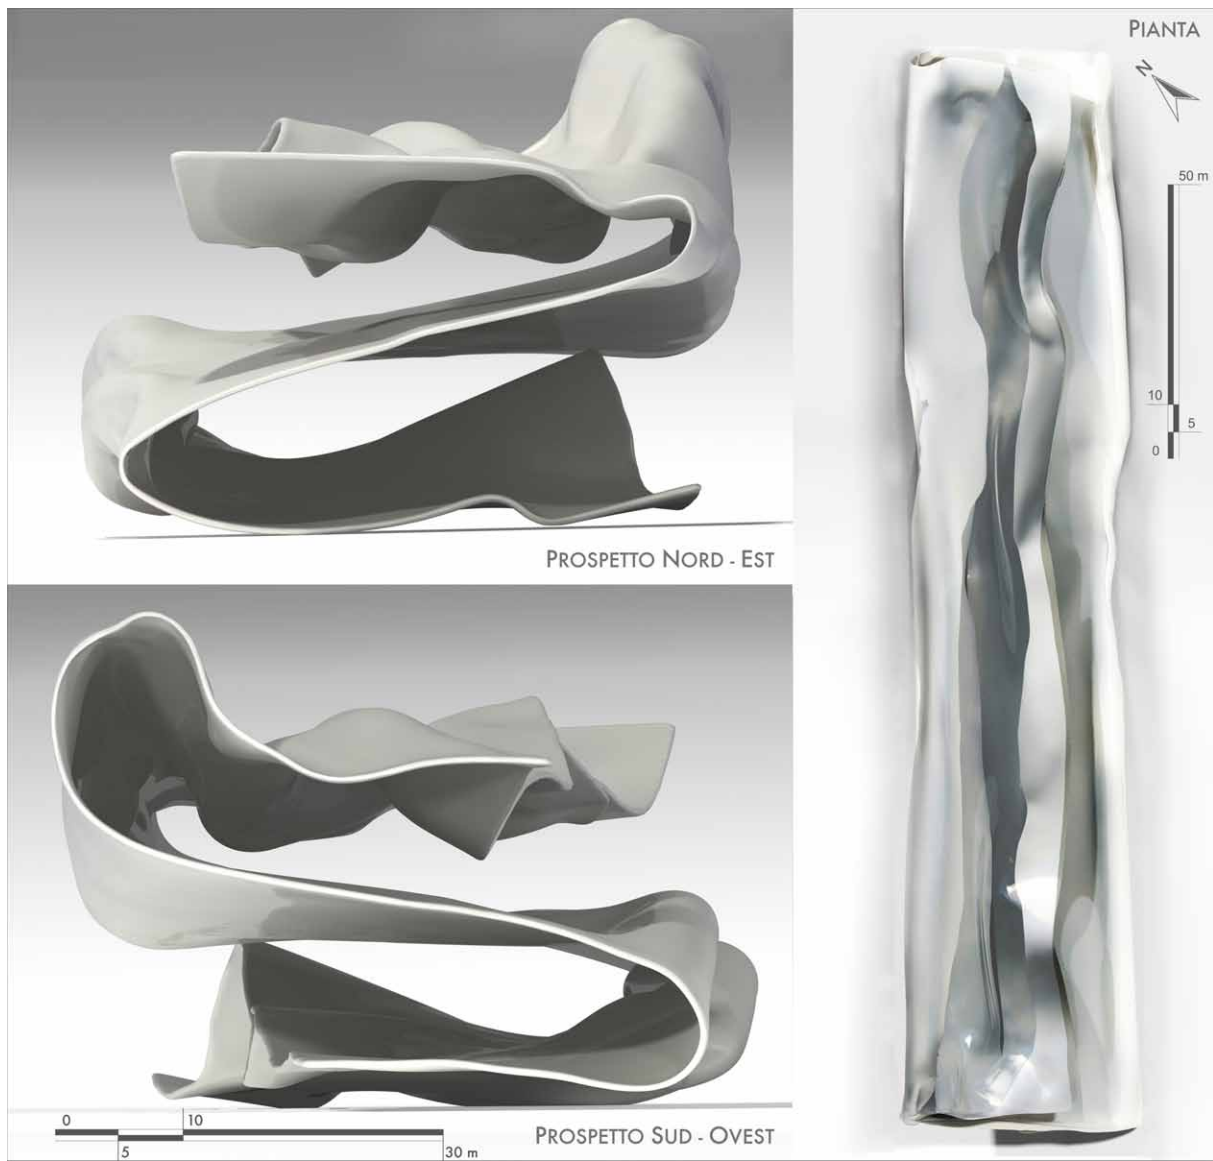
Pianta del piano di copertura e prospetti laterali
